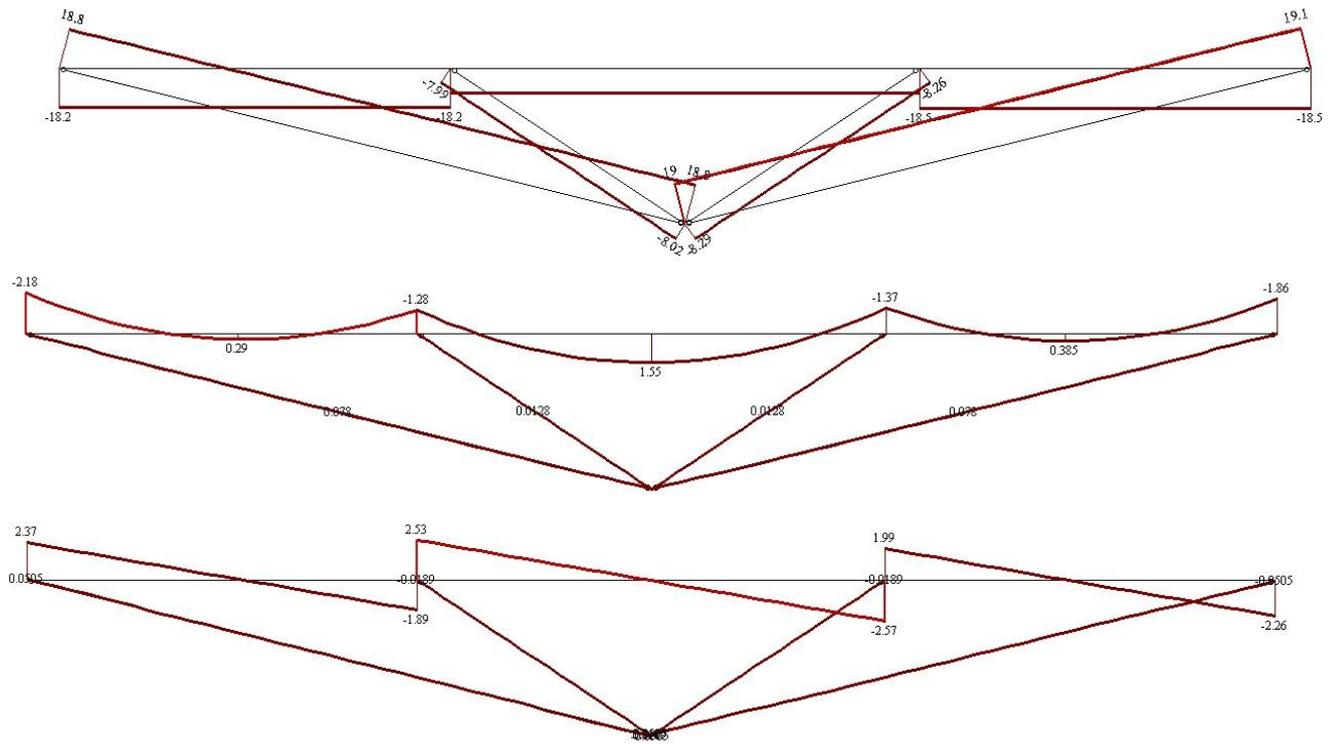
Эпюры продольных сил, изгибающих моментов и поперечных сил в стропильной ферме при неблагоприятном сочетании нагрузок
